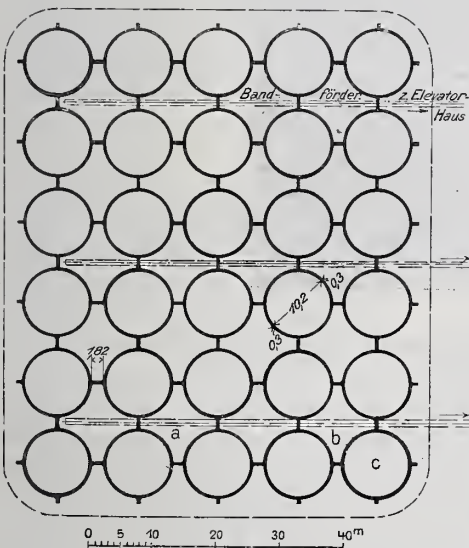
Peavey-Elevator in Duluth. Grundriß.
